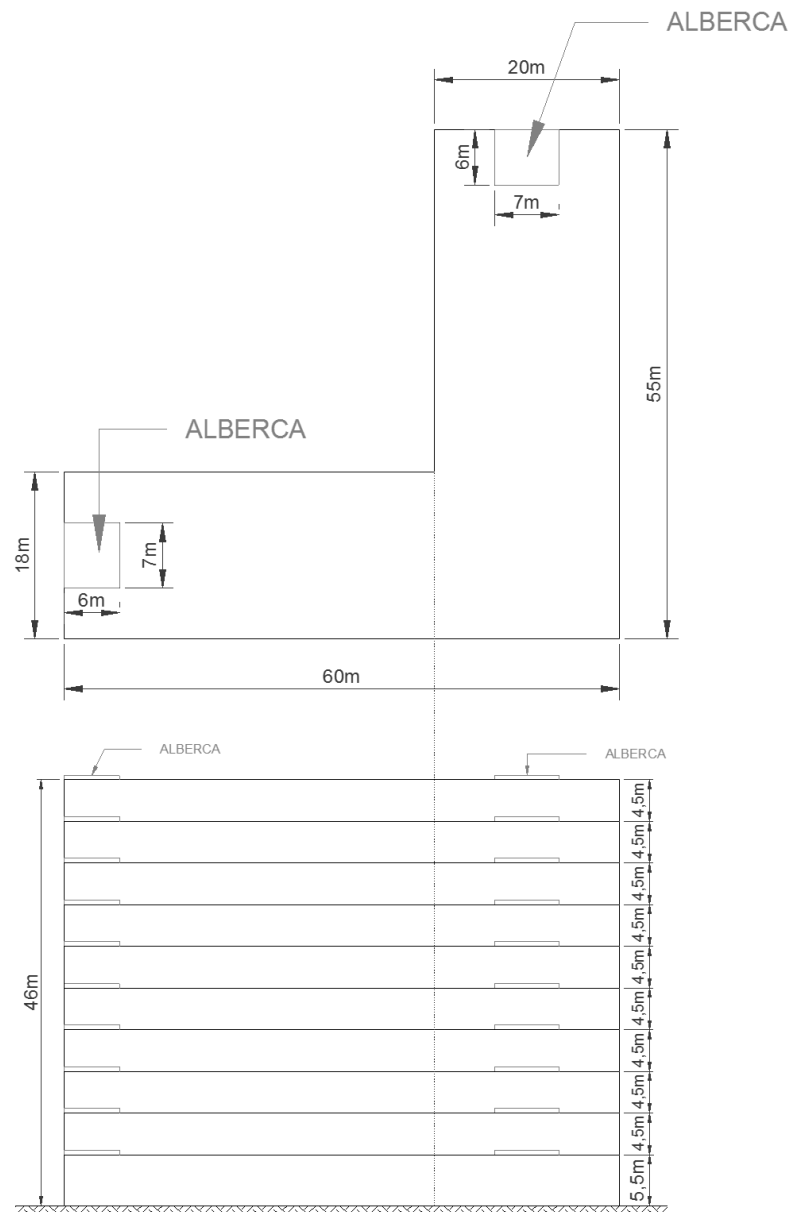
Vista en planta y de perfil de la estructura a diseñar.
